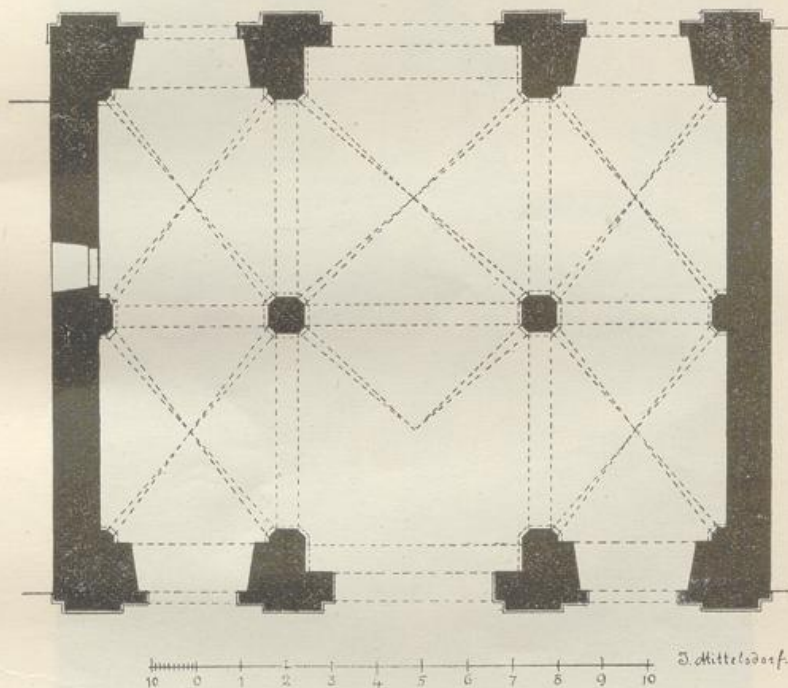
Grundriss des Frankfurter Thores.
